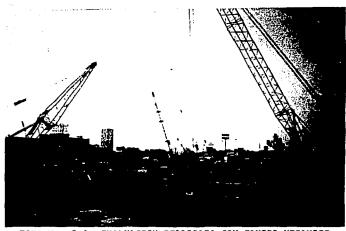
EXCAVACION REALIZADA CON EQUIPO MECANICO DESDE LA SUPERFICIE.
